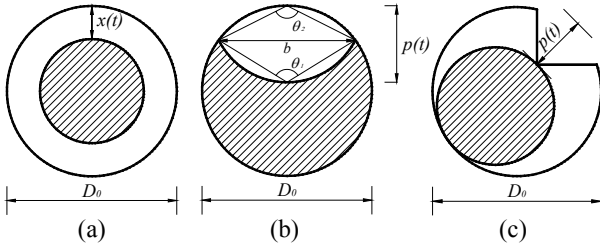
Riduzione della sezione di una barra di armatura: (a) corrosione uniforme; (b), (c) corrosione per pitting.
